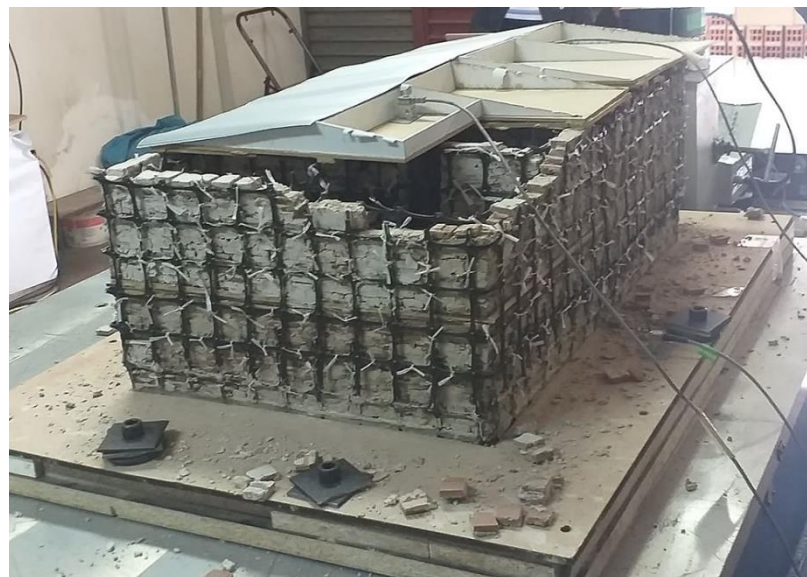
se aprecia el desprendimiento de bloques de adobe en los muros traseros del segundo nivel del espécimen reforzado con geomalla. Fuente: Imagen propia, 2019
